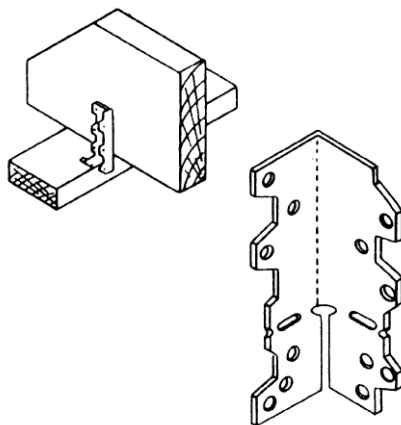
Стальной кронштейн, используемый для крепления потолочной балки к верхнему брусу. Кронштейн отгибается при установке
